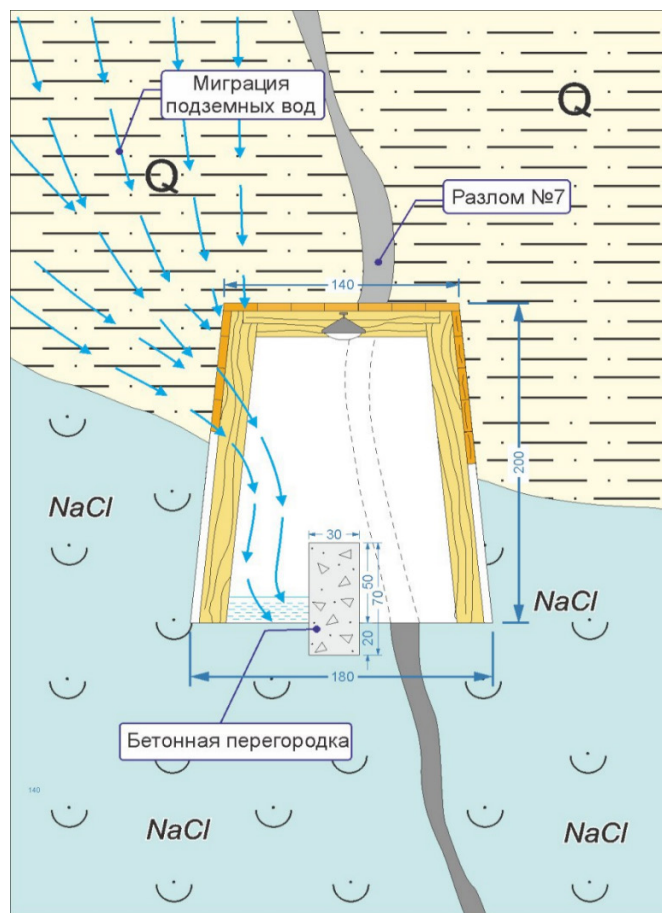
Схема проходки штрека и возведения бетонной перегородки
